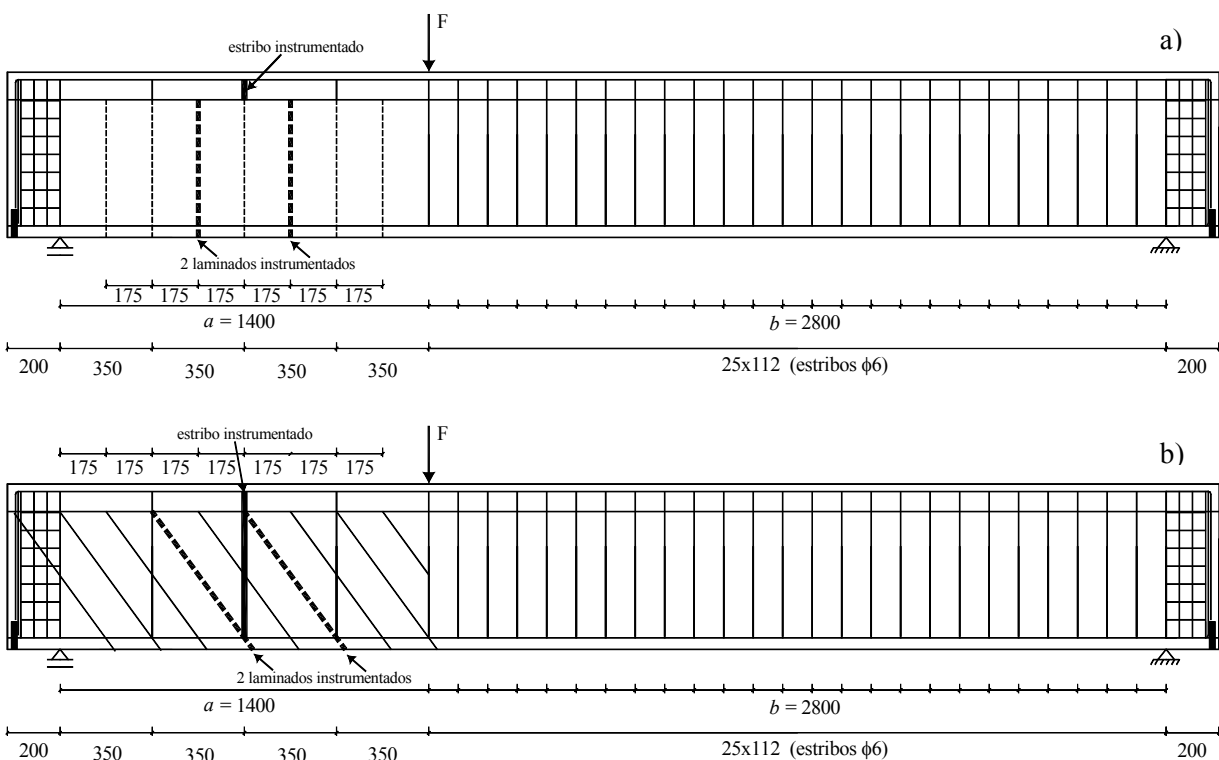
Localização dos estribos e dos laminados de CFRP instrumentados: a) reforço com laminados verticais (vigas 3S-7LV-M e 3S-7LV-C); b) reforço com laminados inclinados a 52° (vigas 3S-9LI-M e 3S-9LI-C).
